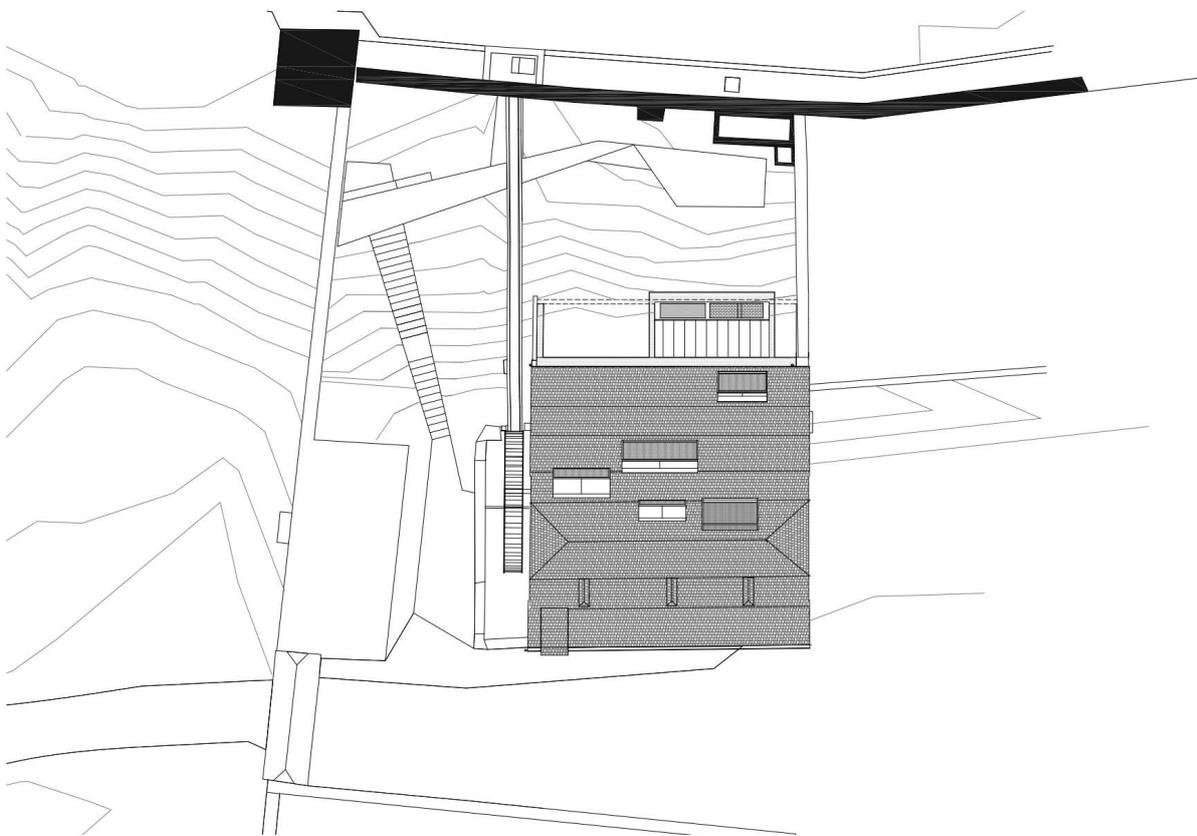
Plan de toiture réalisé par Binario architectes (s.d.)
